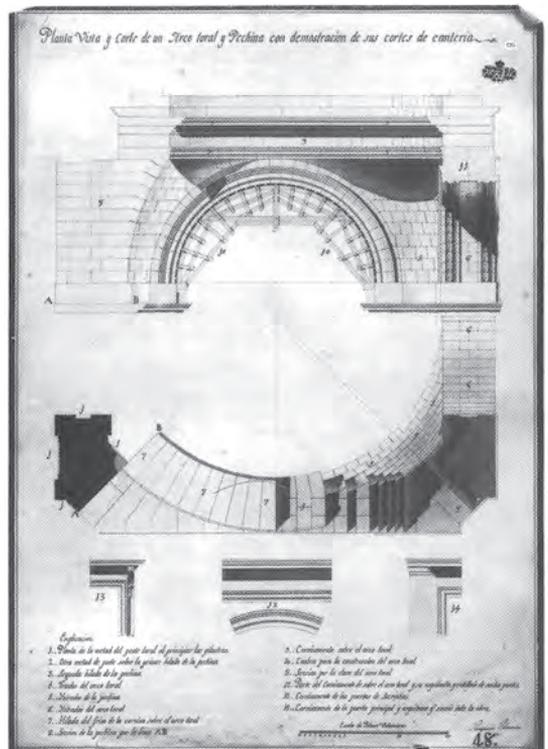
Planta, alzado y sección de un arco toral y pechina con demostración de sus cortes de cantería, de un proyecto de “Yglesia en forma de cruz griega dedicada a la Resurreccion del Señor”, de Josef Ariño. 1797. (Bérchez 1981, 142).
